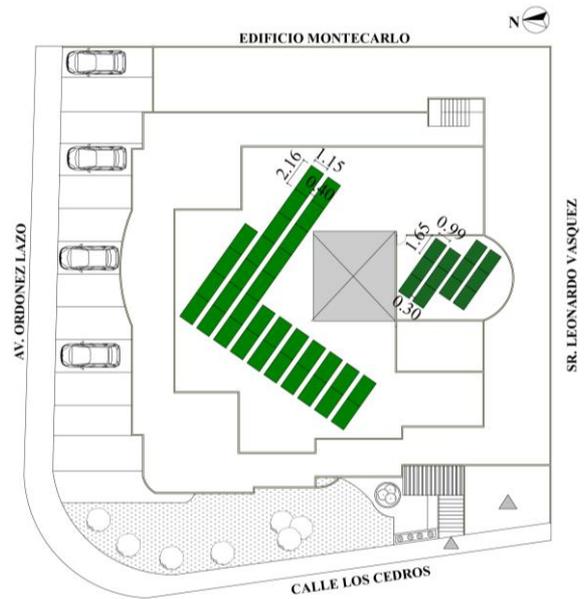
Planta arquitectónica de la ubicación de paneles solares y colectores solares.
